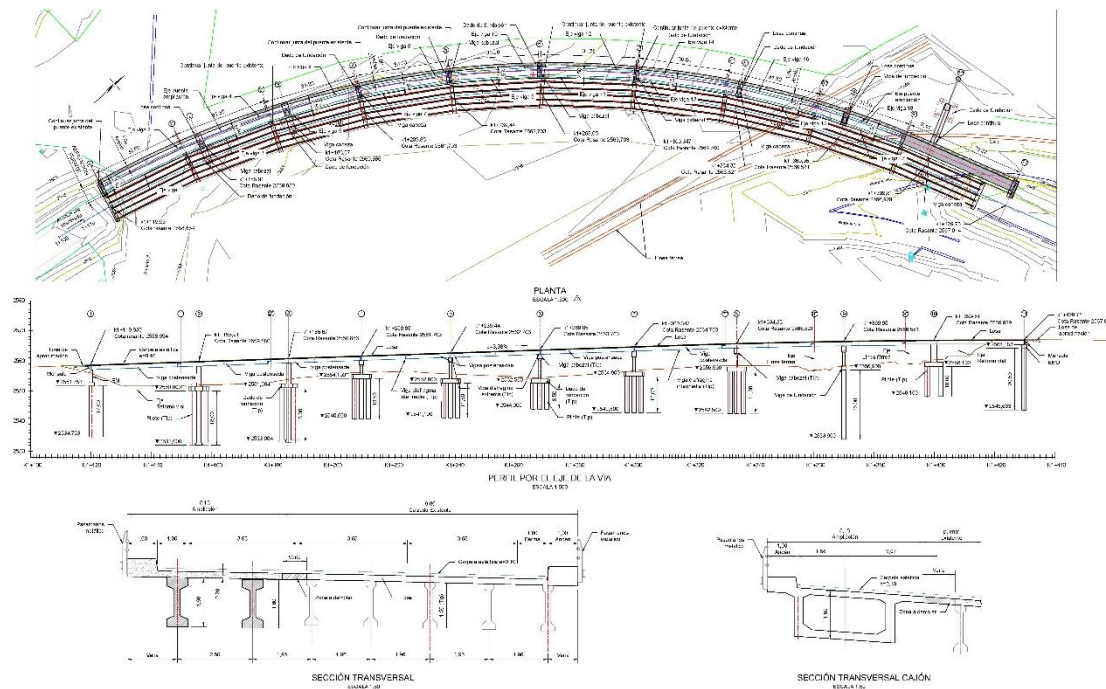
Planta- Detalles Generales de la ampliación del puente de La Caro
